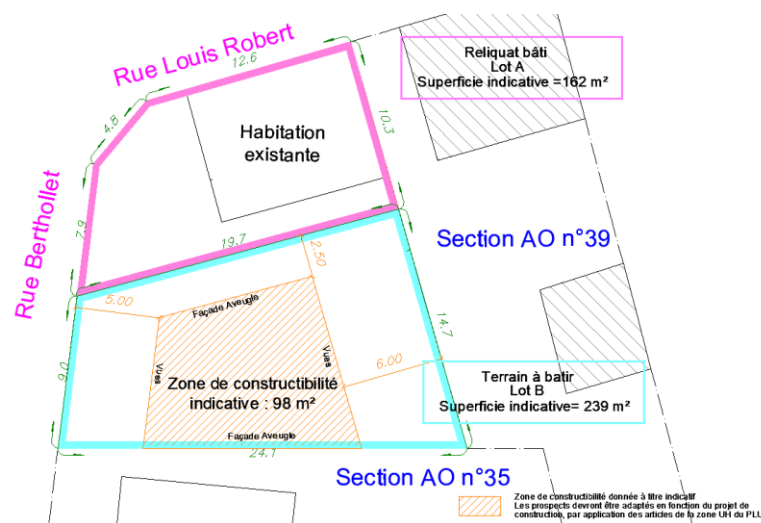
Plan projet avec la zone de constructibilité maximale, PLU 2014, 2016 et 2017
